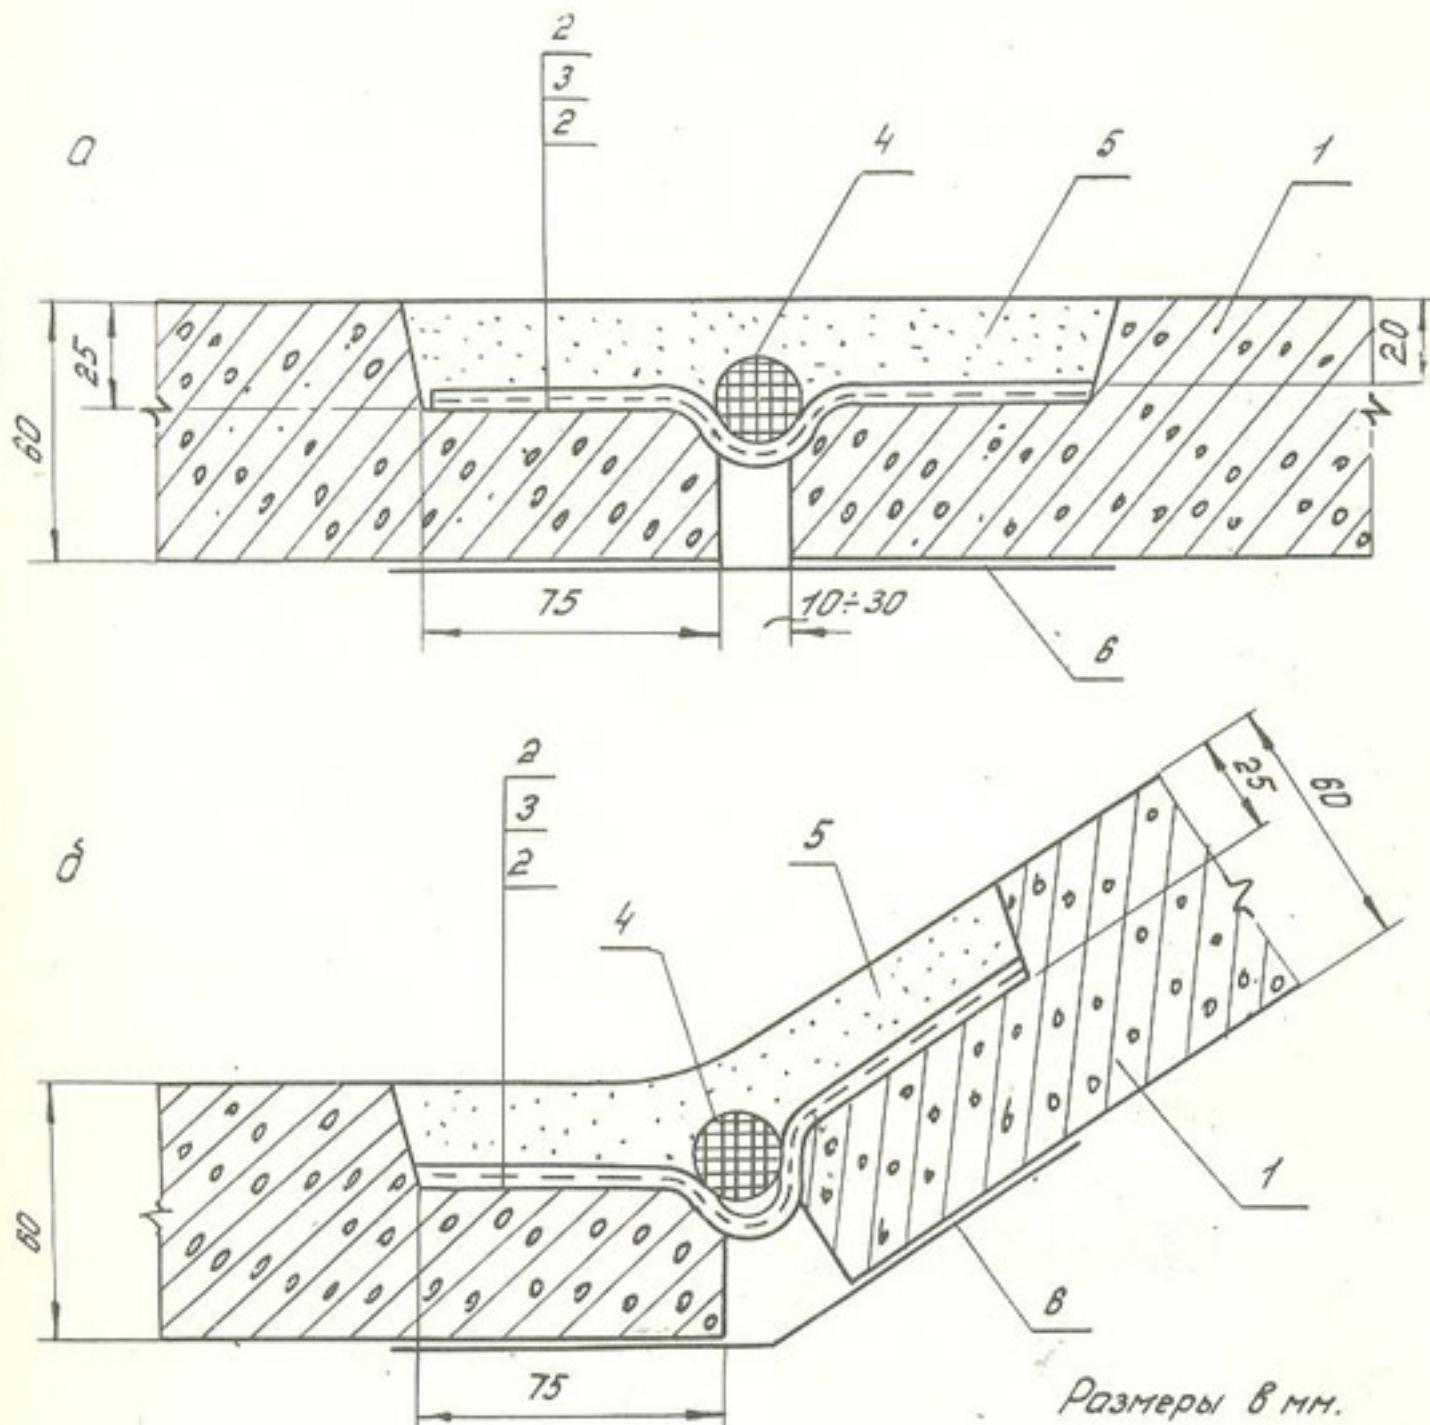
Герметизация стыка оклеечным стеклоизолом с пороизоловым жгутом: а-откосный и донный поперечные швы; б-донный продольный шов. 1-ж.б.плита; 2-изоловая мастика; 3-стеклоткань; 4-пороизол ϕ 20; 5-песчаный бетон (или асфальтовый раствор); 6-подкладка (толь, руберойд)
